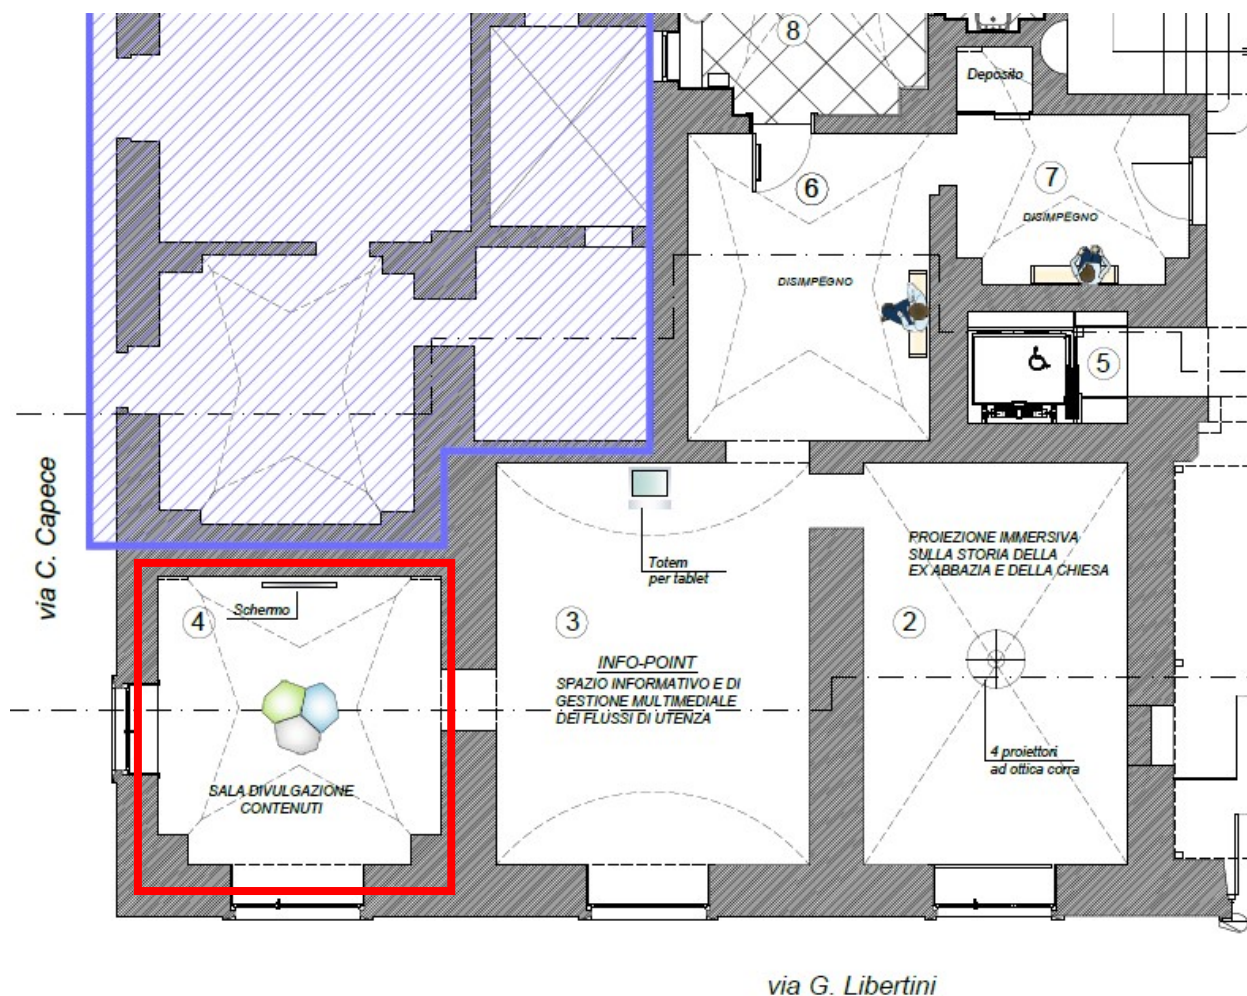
Stralcio della planimetria del piano terra con individuazione della sala divulgazione (rosso)
